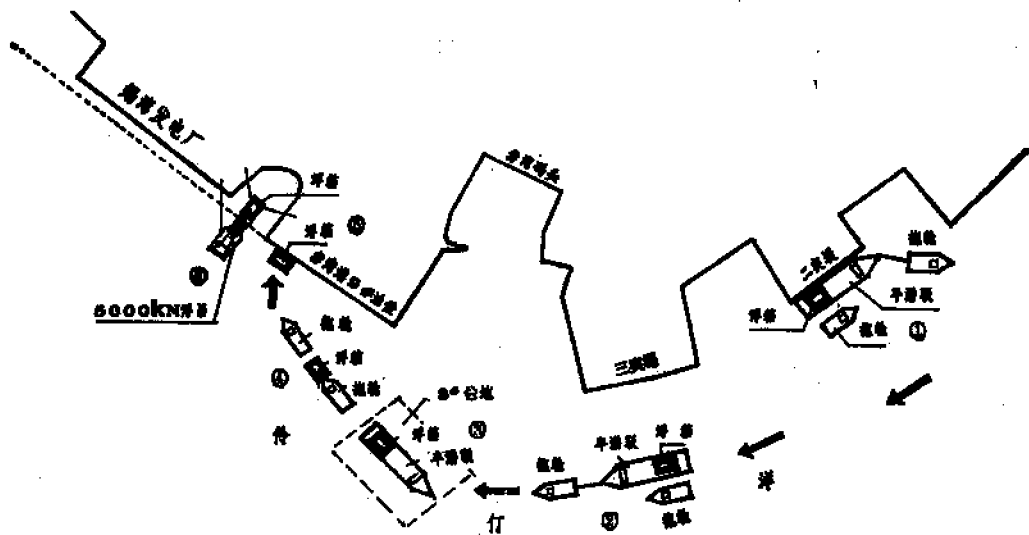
(7) 半潜驳浮箱法施工过程平面示意图
